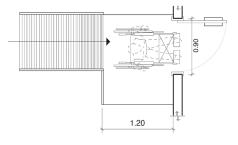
Planta de rampa e Ingreso. CONADI 71.
